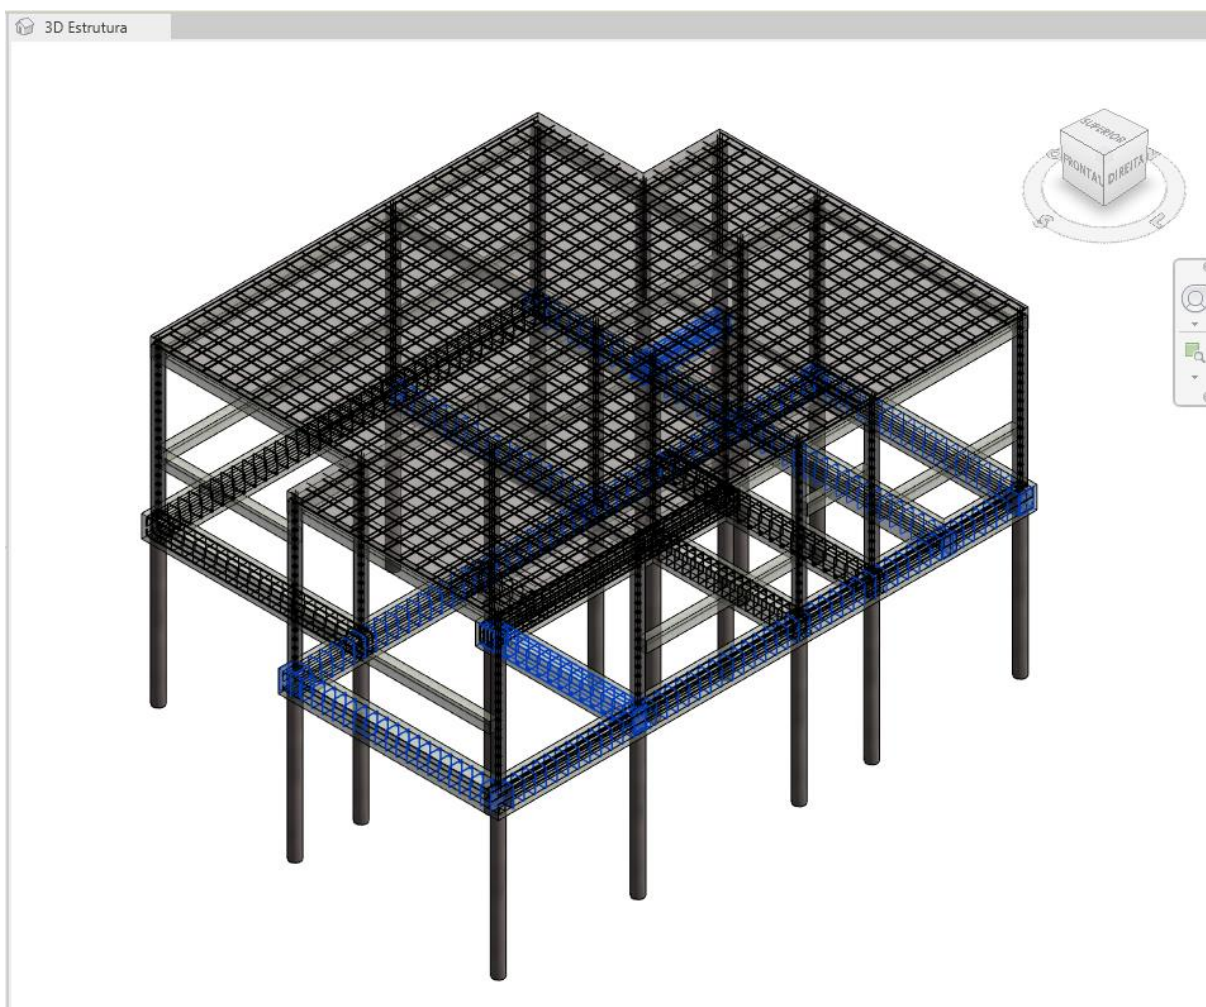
Modelo estrutural com armaduras destacadas.
